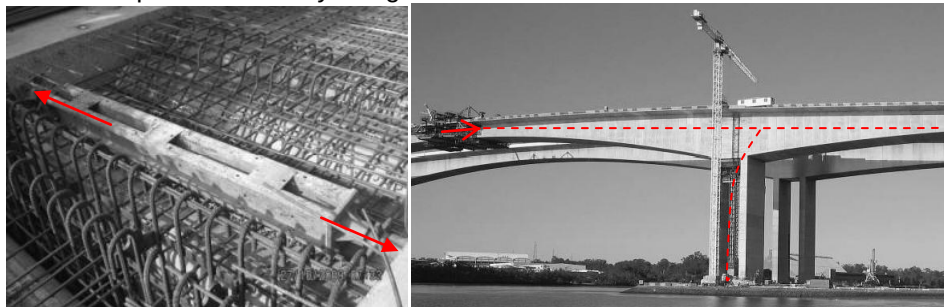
Columnas metálicas y gatos hidráulicos instalados en la dovela de cierre durante la construcción del puente Gateway Bridge.
